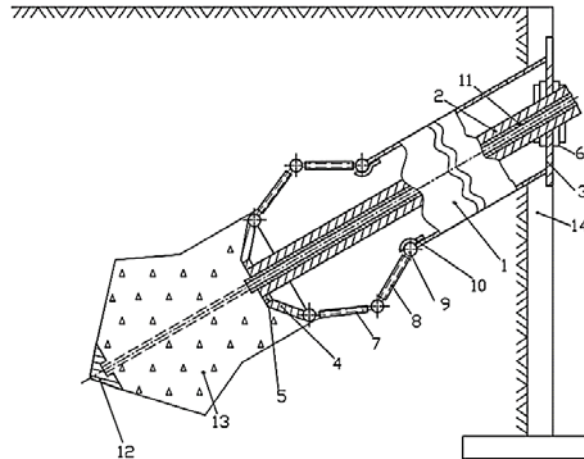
Схема закрепления подпорной стенки анкерной свай: 1 — обсадная труба; 2 — полый металлический сердечник; 3 — верхняя пластина; 4 — нижняя пластина; 5 — проставка; 6 — муфта; 7 — сегменты; 8 — ролики; 9 — шарниры; 10 — кожух шарнира; 11 — арматура; 12 — заглушка полого сердечника; 13 — бетонная смесь; 14 — подпорная стенка
